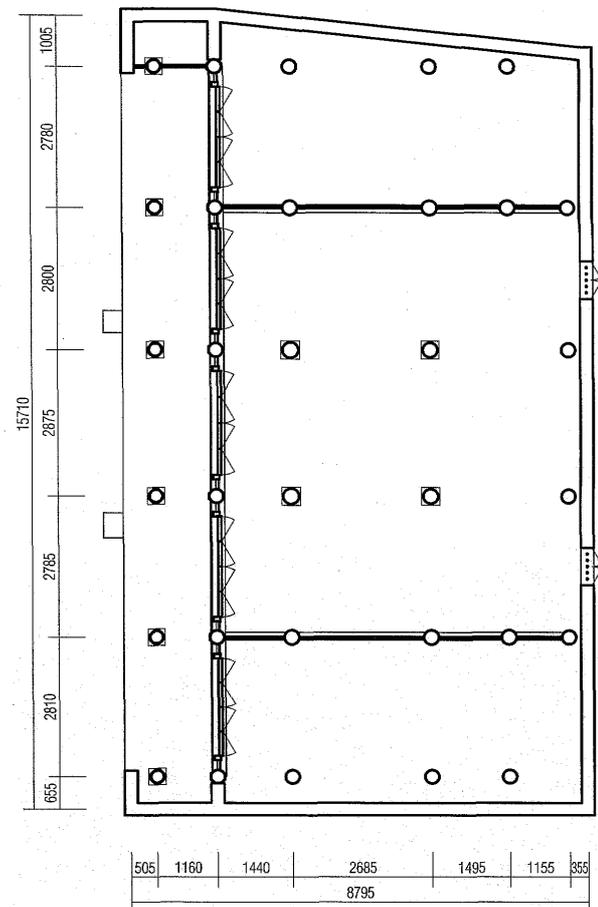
Cao Van Toan邸 主屋 平面図 1:150
